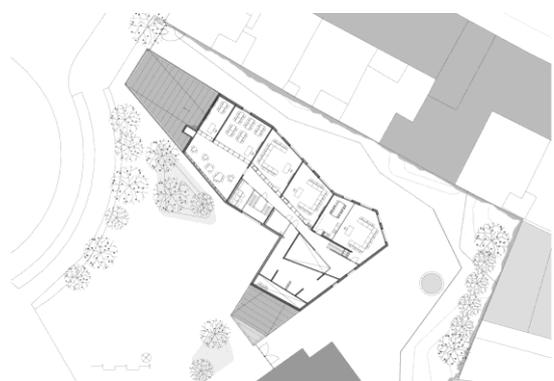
GalijoenSchool, Дания (план 2-го этажа)
